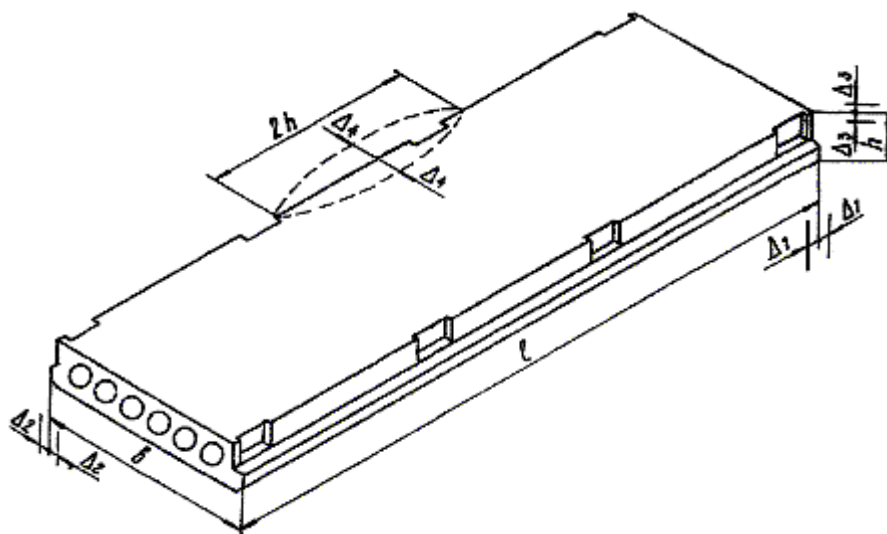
Схема плиты перекрытия ПК8-58-12
